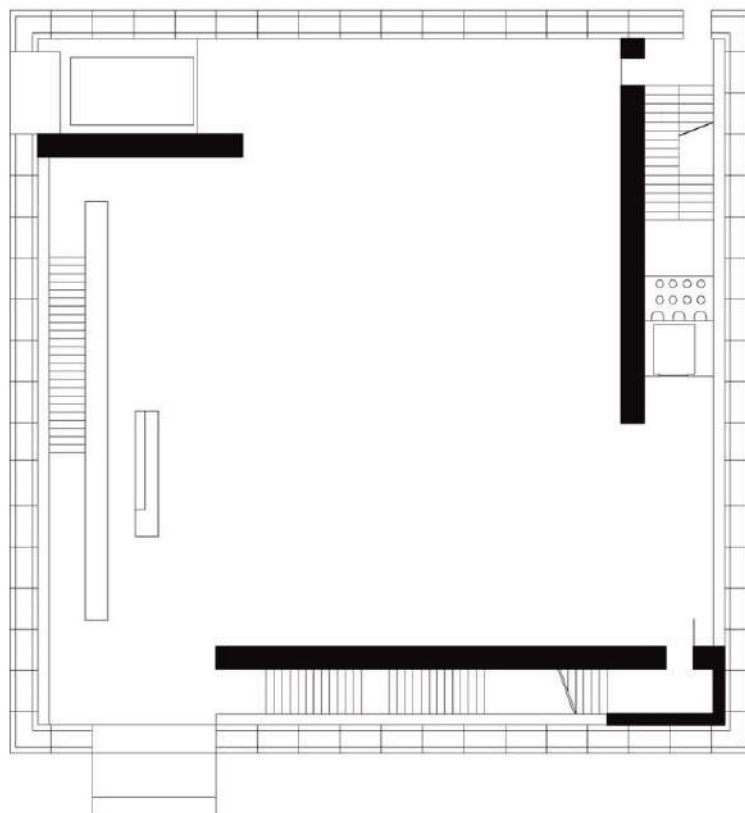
Planta piso 0 do Kunsthhaus Bregenz
